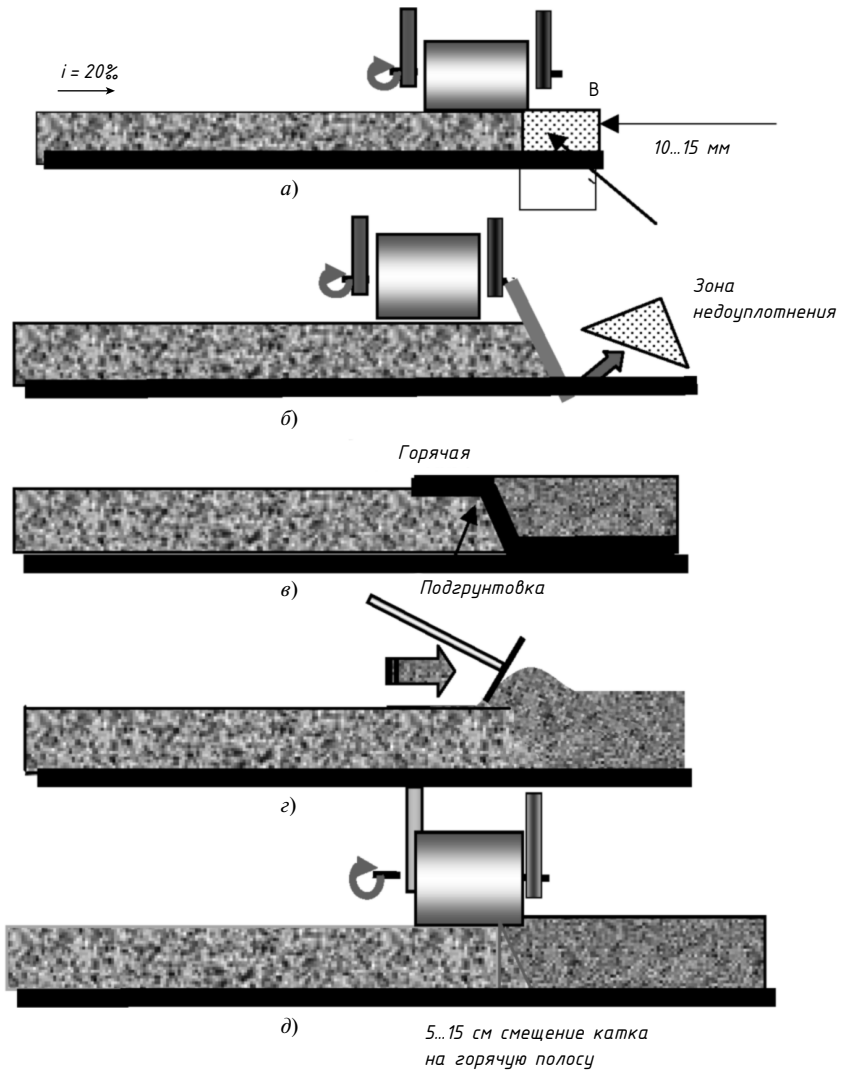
Основные этапы устройства продольного стыка между полосами укладки на асфальтобетонном покрытии с удалением недоуплотненной зоны:
